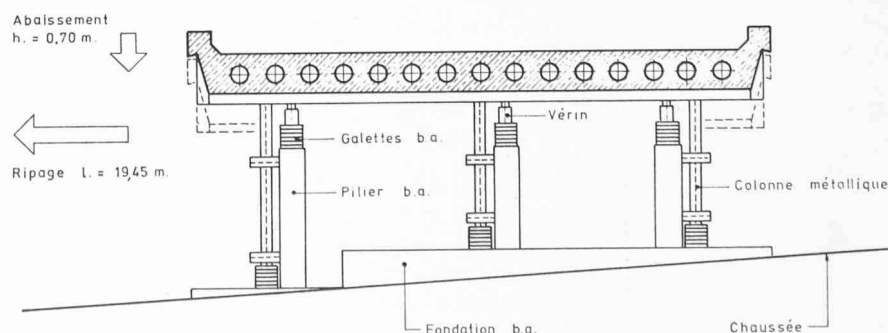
Passage inférieur de Malley : dispositif pour l'abaissement de la dalle (3 colonnes métalliques + 3 vérins de chaque côté de la chaussée).
